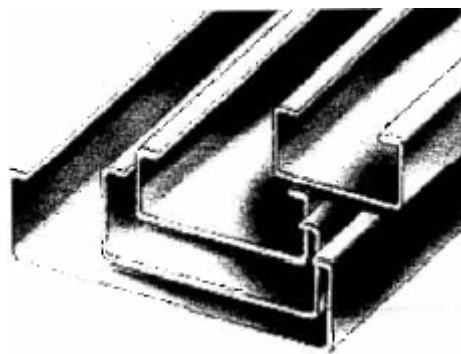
Perfis “Tipo C” utilizados na estrutura de sistemas construtivos LGSF [14]
